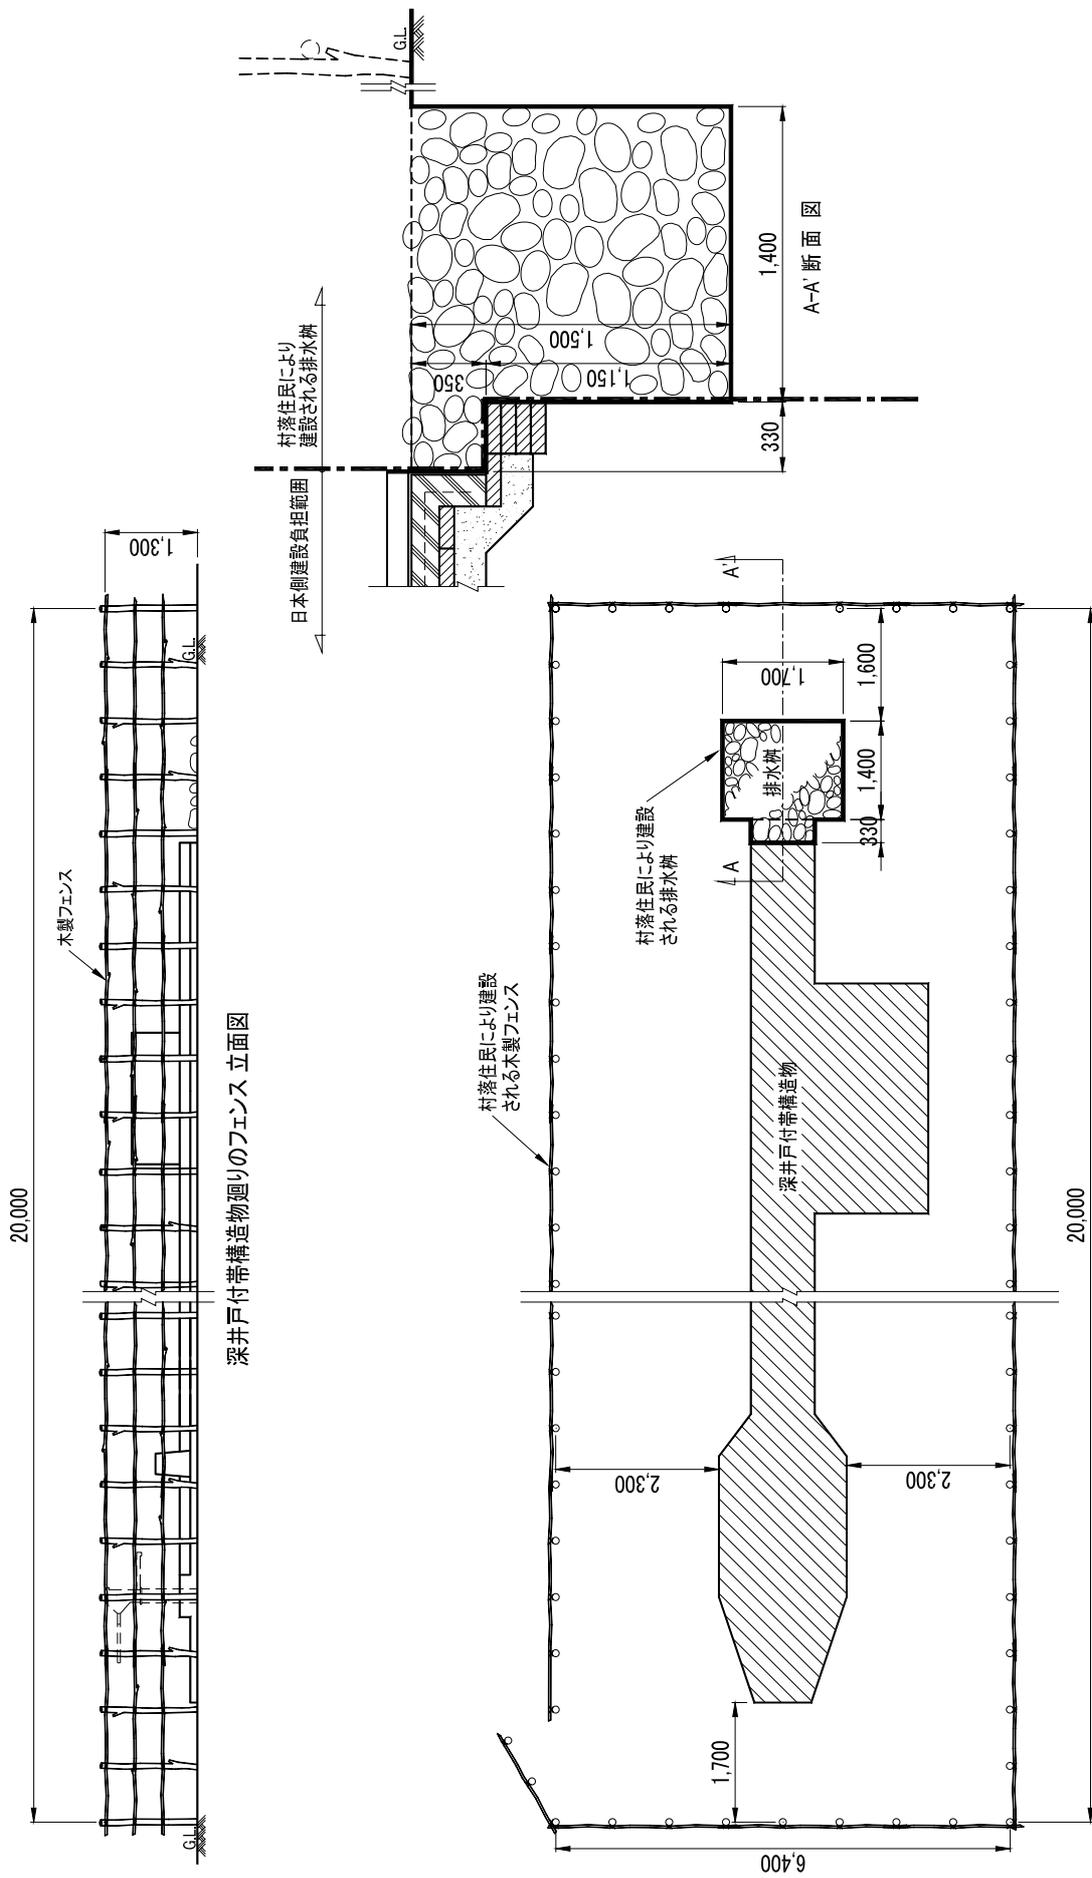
2 - 7 深井戸構造物廻りの木製フェンス及び排水路 平面図・立面図・断面図 (参考図)
